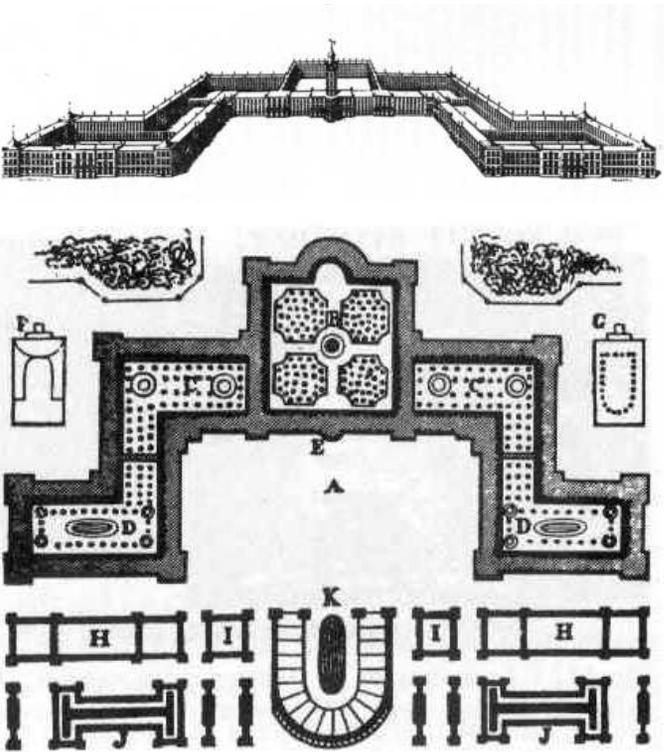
Fourier, vista prospettica e planimetria del Falansterio
